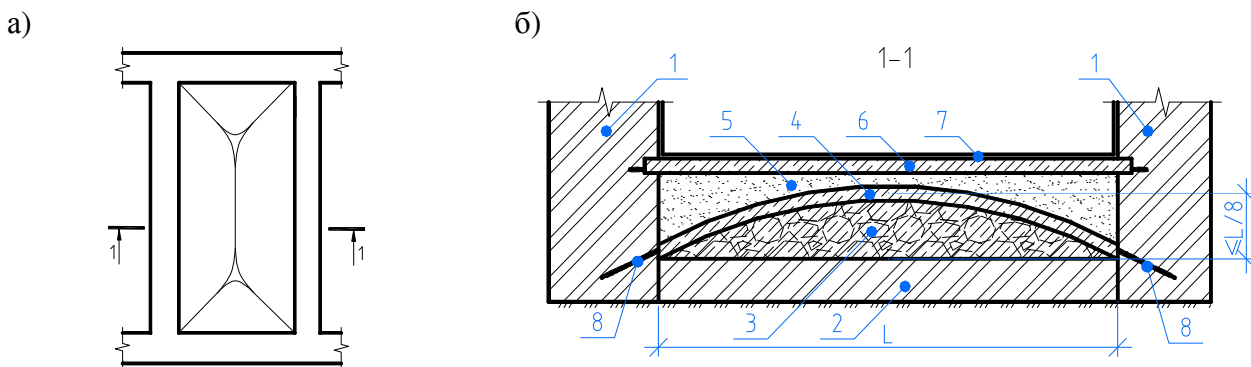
Железобетонная предварительно напрягаемая оболочка: а) план; б) разрез: 1-существующие кирпичные стены подвала; 2-кирпичный неармированный исторический пол; 3- крупный щебень с нагнетенным ц/п раствором с повышенным сопротивлением фильтрации воды; 4-ж/б оболочка; 5 - песок средней крупности; 6 - ж/б армированный пол подвала; 7 – гидроизоляция по горизонтальным и вертикальным поверхностям. 8 – глухой анкер.
